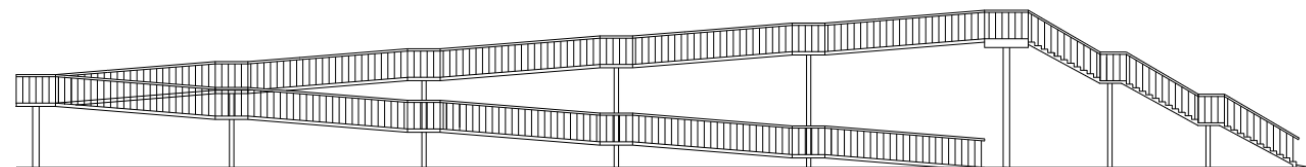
Alternativa 1 de rampas y escaleras. Fuente: Elaboración propia.
